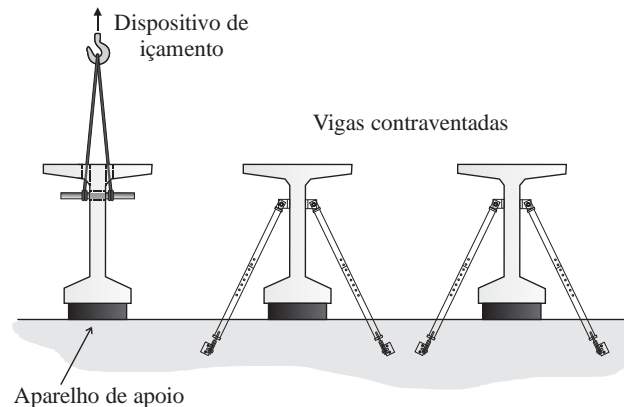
Vigas contraventadas e vigas sobre aparelho de apoio sem travamento
